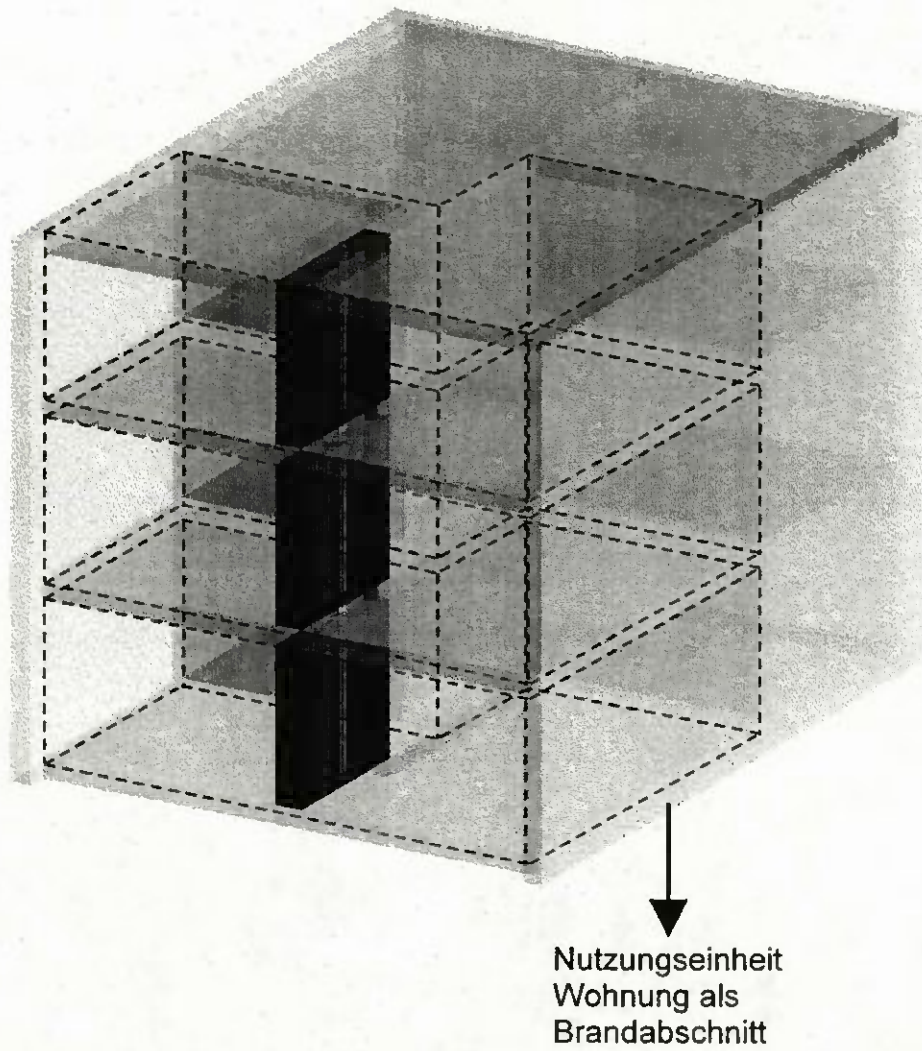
Einbindung der vorgefertigten, geschosshohen Installationskerne in das Gebäude. Im Geschosdeckebereich durchbrechen nur die Rohrleitungen die Brandabschnitte.
